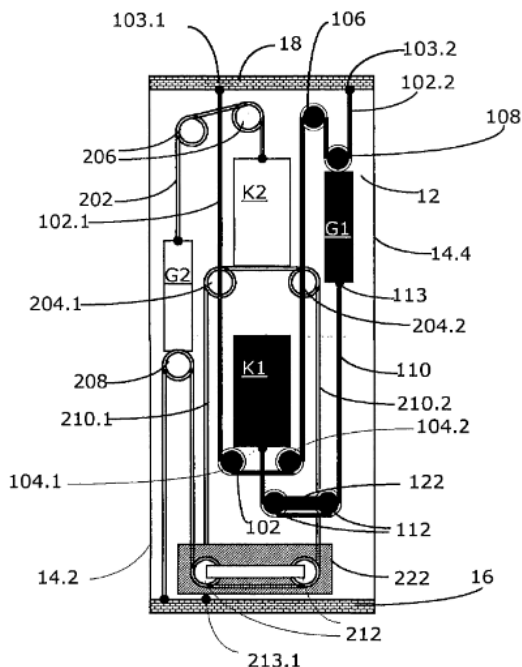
Схема расположения кабин в шахте лифта: K1, K2 – кабины; 102, 202 – несущее-тяговое устройство; G1, G2 – противовесы; 110, 210 – нижний канат; 104, 224 – утяжелитель; 213 – крепление каната.
